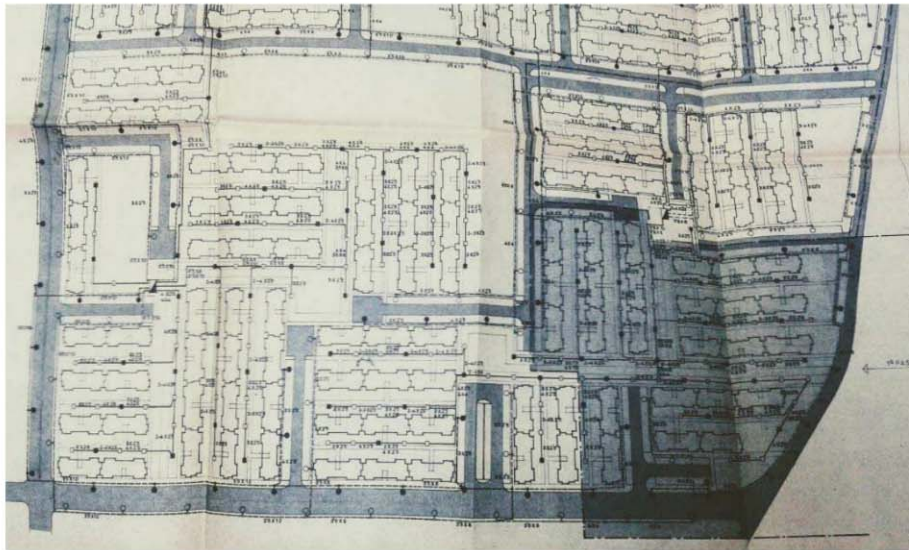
Localización del primer grupo de 500 viviendas construido entre 1973 y 1974. Plano original
